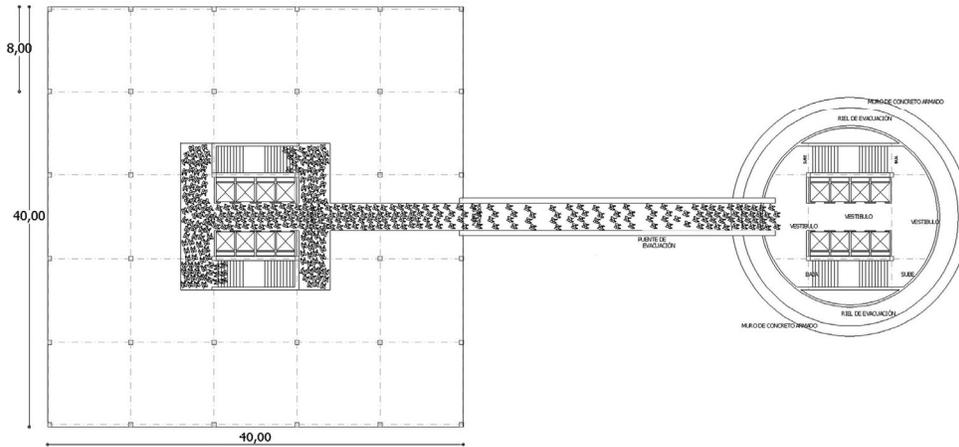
Planta arquitectónica del edificio modelo y espacio seguro alterno.
